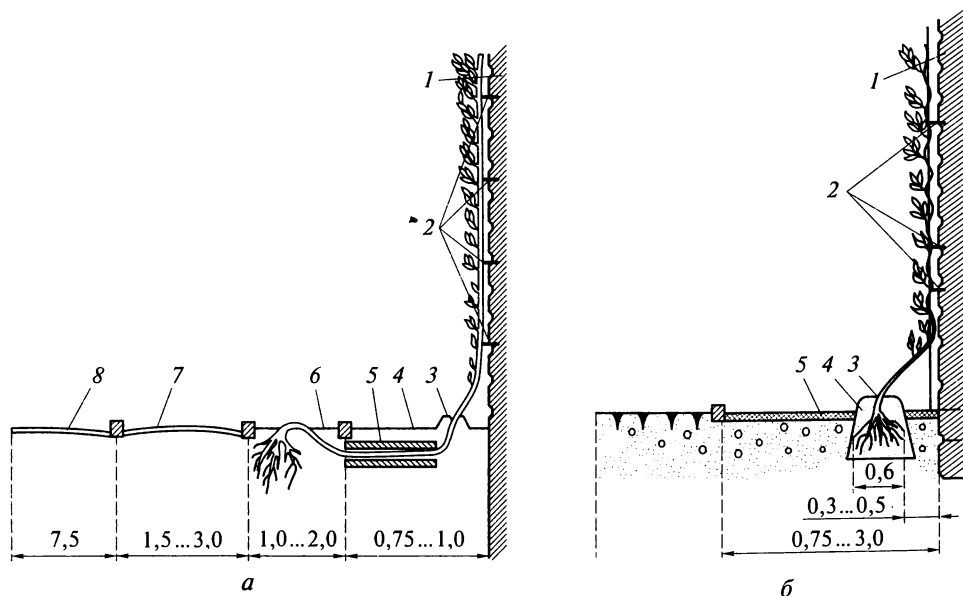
Схемы размещения и посадки лиан у стен зданий (размеры указаны в м):
